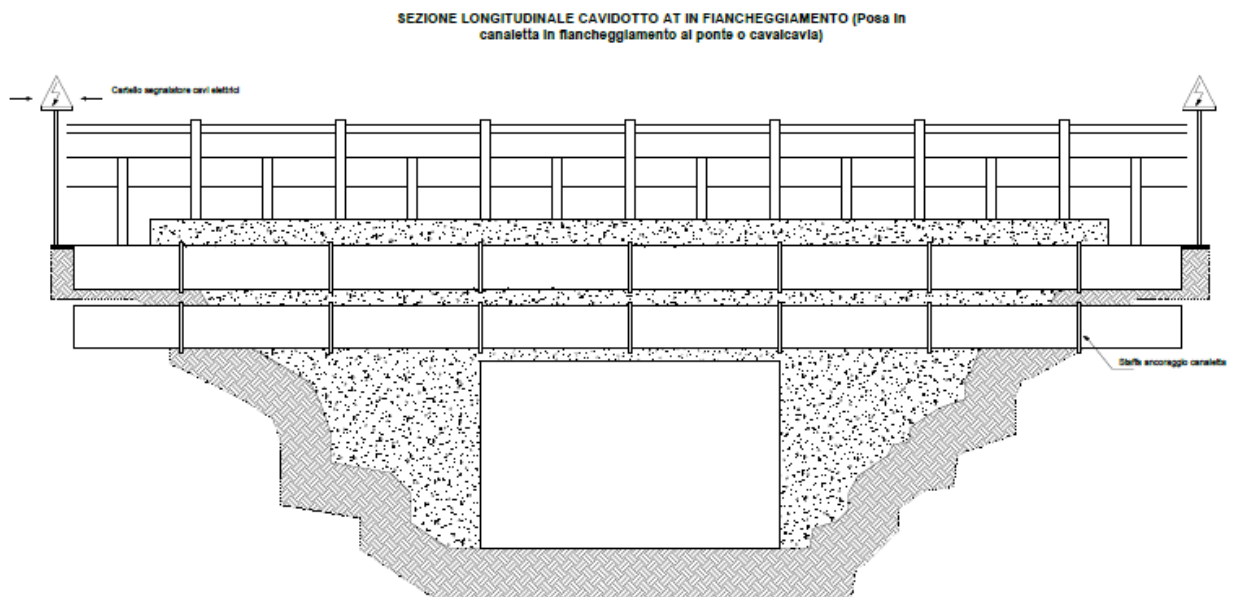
Sezione longitudinale cavidotto AT in fiancheggiamento al ponte o cavalcavia.
